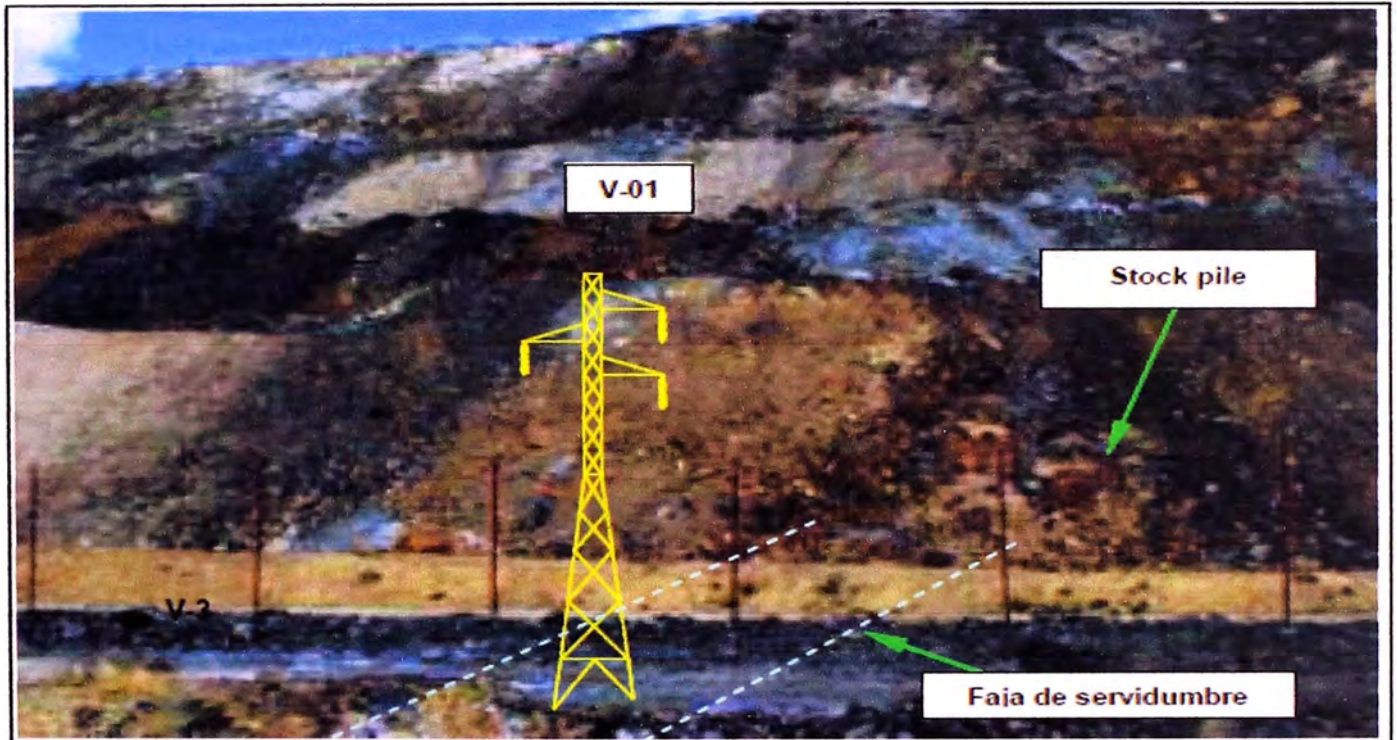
Vértice V-1 Estructura alejado del Stock pile
